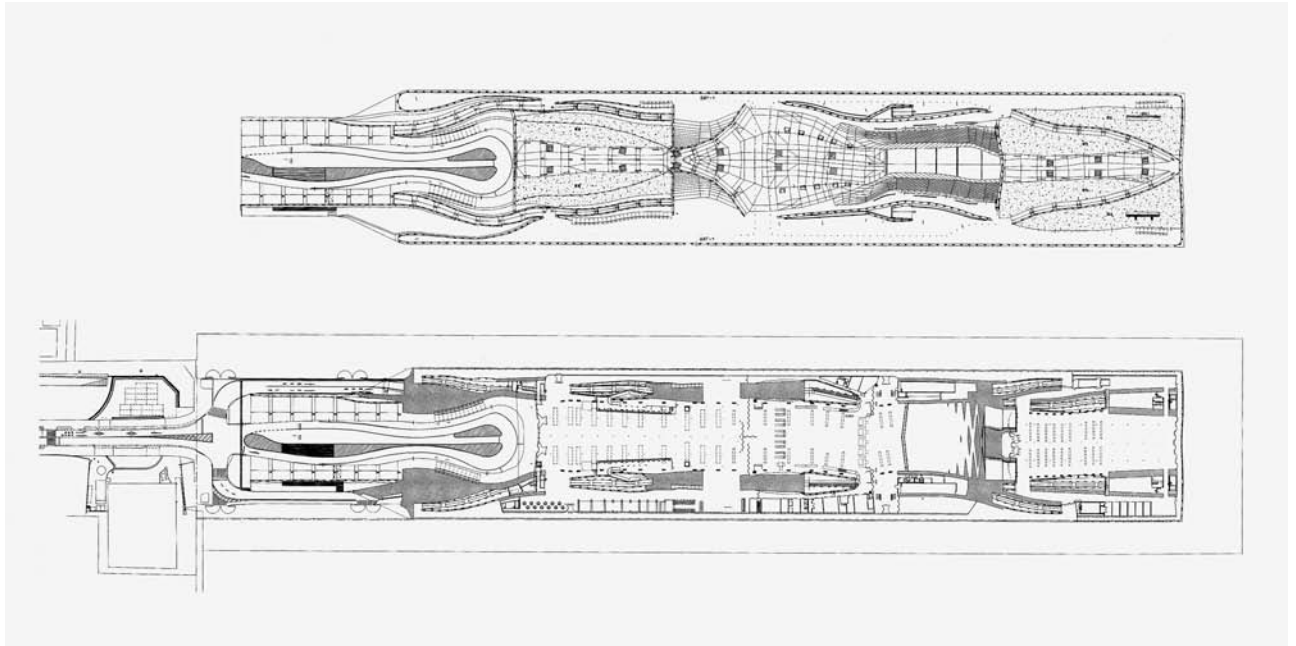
Farshid Moussavi und Alejandro Zaera-Polo/FOA, Yokohama International Port Terminal, Japan, 1994–2002. Ausführungsentwurf, Dachaufsicht und Grundriss Terminalebene, Computerzeichnungen.
